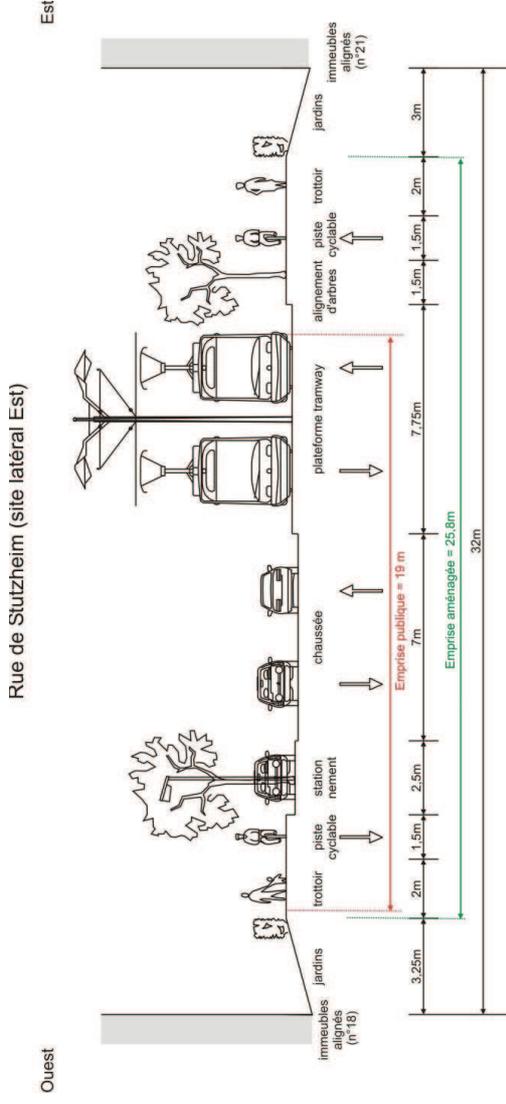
Situation projetée (coupe 5) sur la rue de Stutzheim (site latéral Est)
